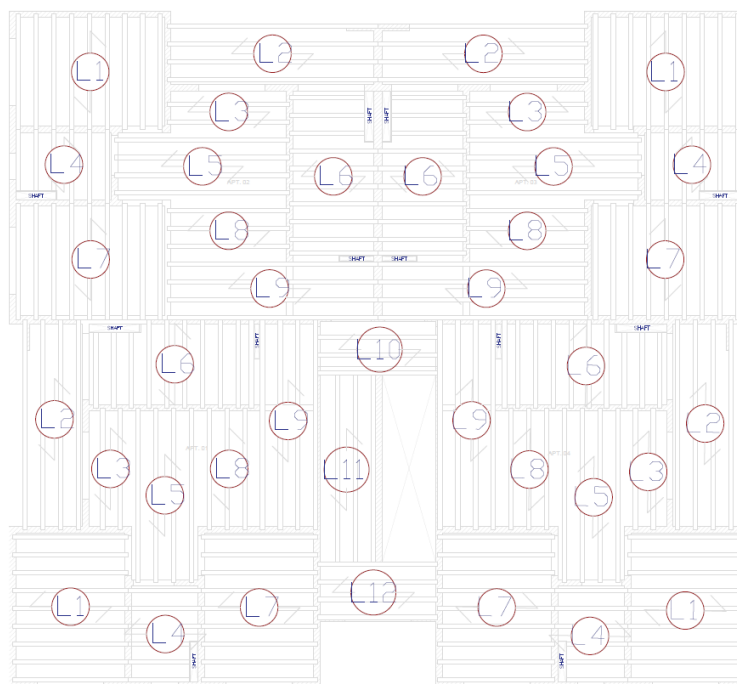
Prancha do projeto estrutural com a disposição dos vãos e treliças, sem escala (Empresa escolhida adaptado, 2018).
